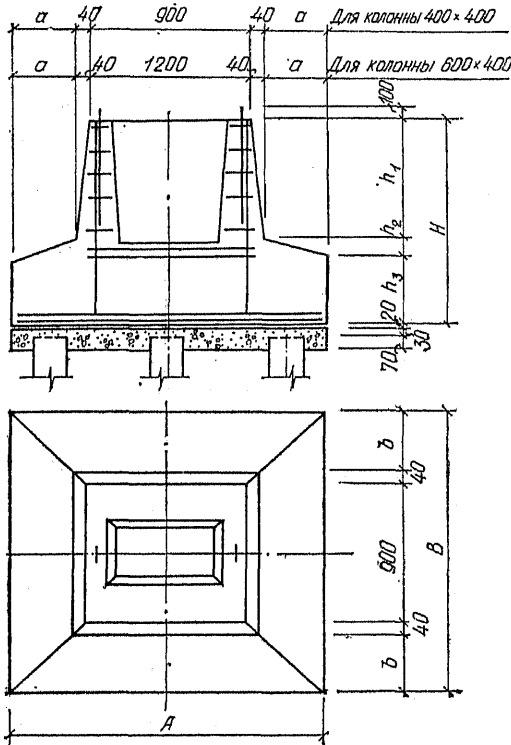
Свайный фундамент со сборным стаканым ростверком
